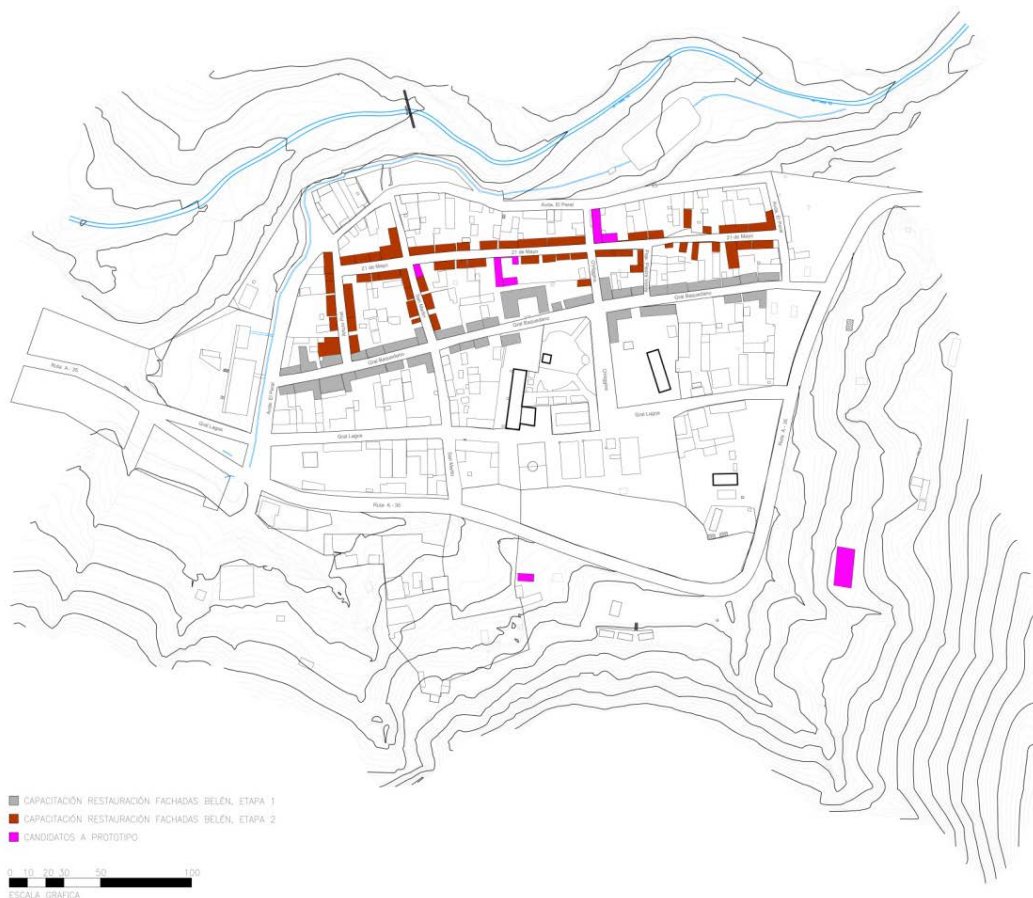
Planta del poblado de Belén con las dos etapas de intervención (Fundación Altiplano)
